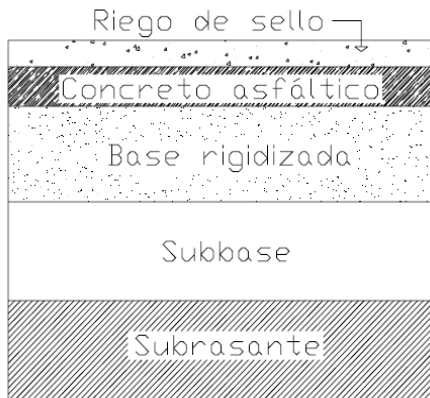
Pavimento flexible de concreto asfáltico.
